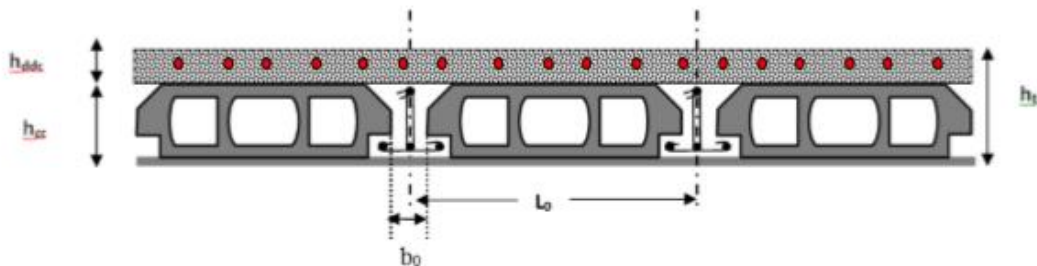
Coupe transversale d'un plancher à corps creux
